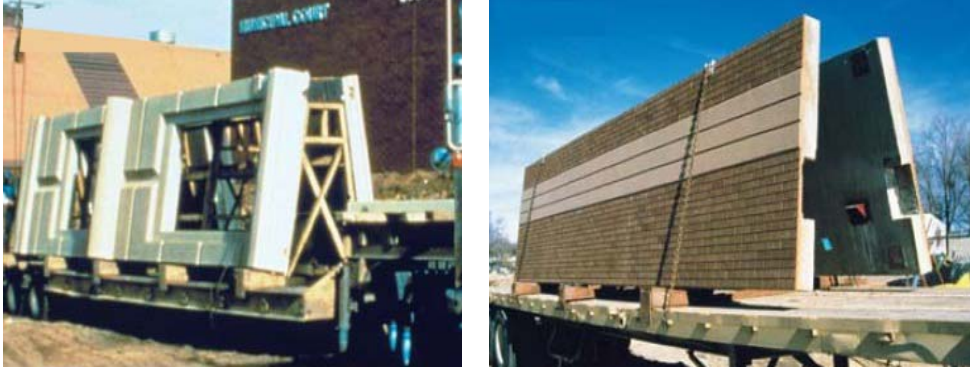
Büyük boyutlu (a) ve küçük boyutlu (b) panellerin istiflenmesi.
